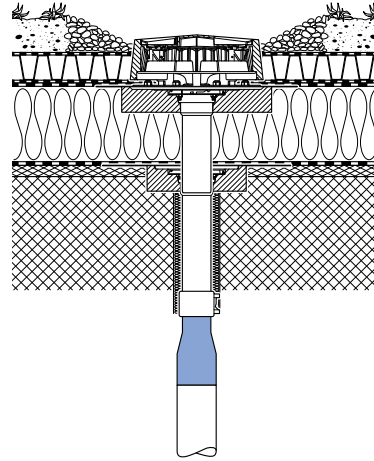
Anschluss des Geberit Pluvia Dachwassereinlaufs mit einer Aufweitung
